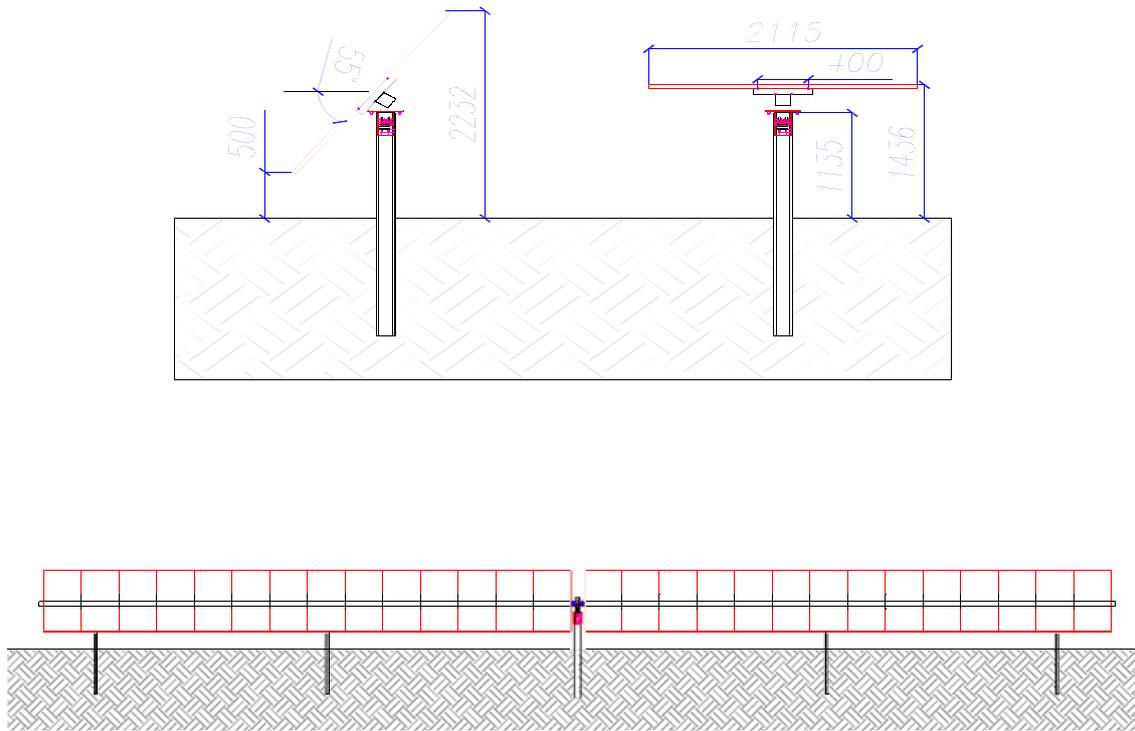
PARTICOLARE DELL'INSTALLAZIONE OMEGA E MONTAGGIO MODULI
